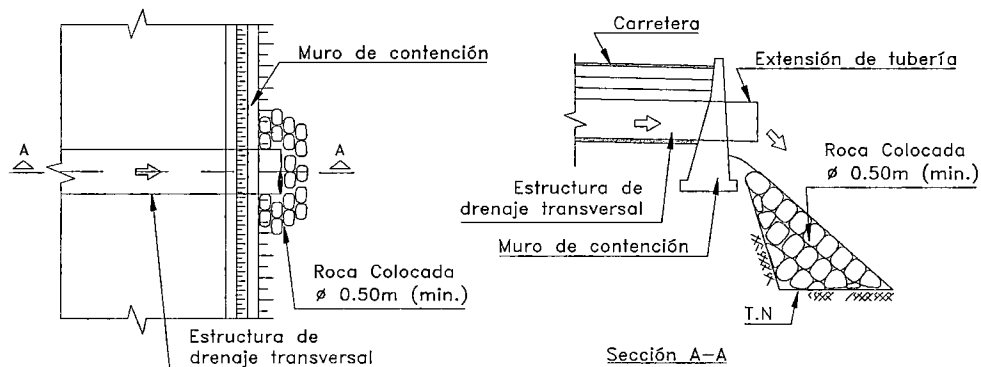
Protección en la Salida de la Estructura de Drenaje Transversal cuando el terreno es de Pendiente Empinada.
